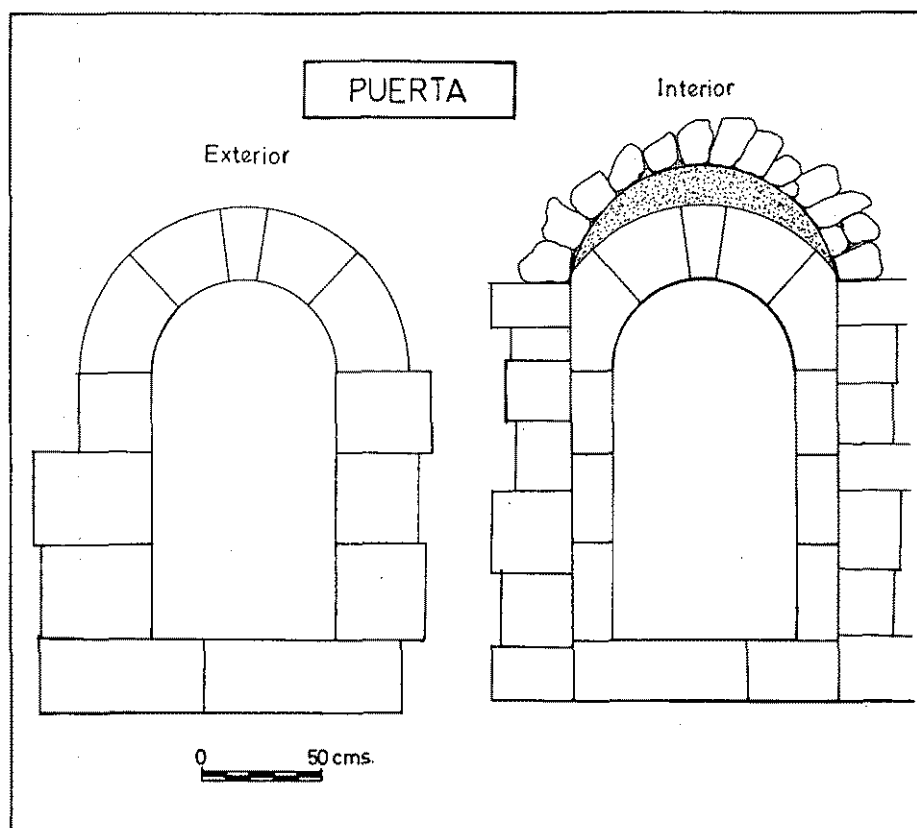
Detalles de la puerta de acceso a la torre de Mascoso, por su parte exterior e interior.
